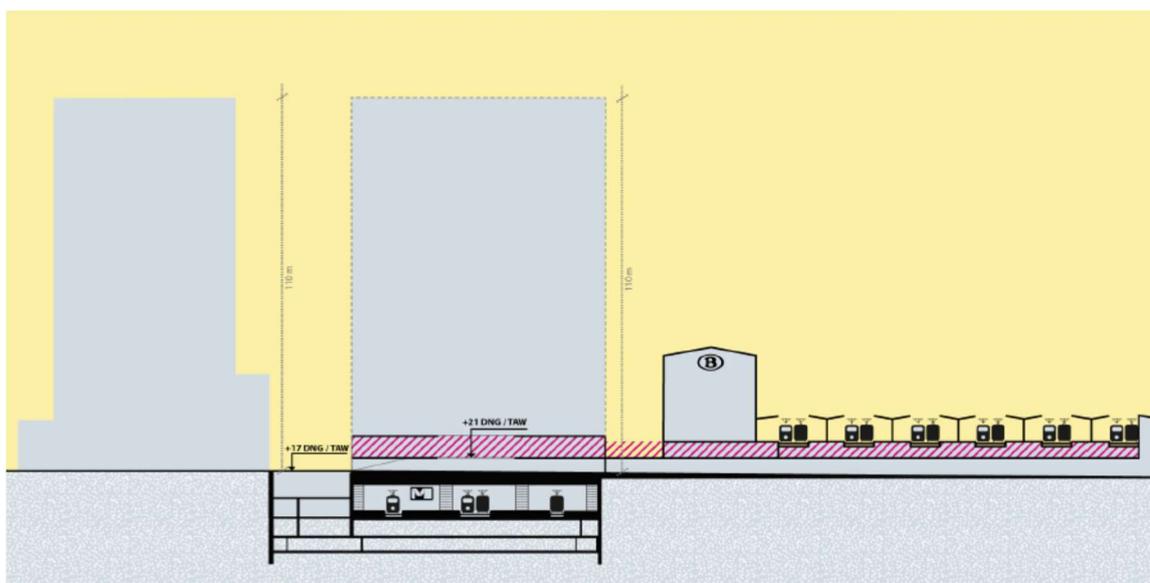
Coupe correspondant au niveau rez-de-gare (+21.00 DNG) du Plan des affectations (illustration @1010)
